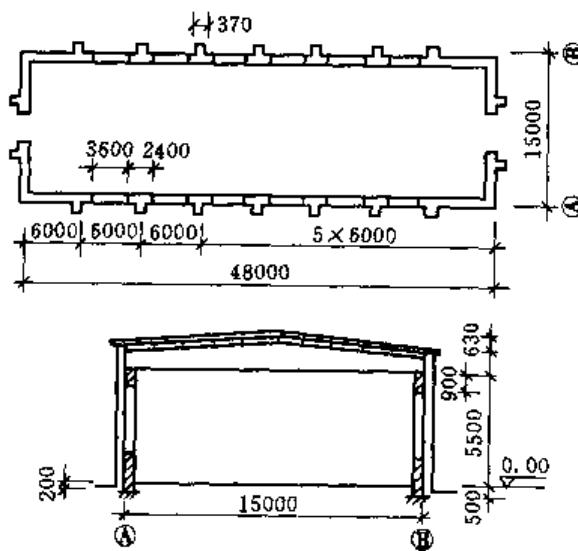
某 15m 跨无吊车厂房示意图 (单位: mm)
